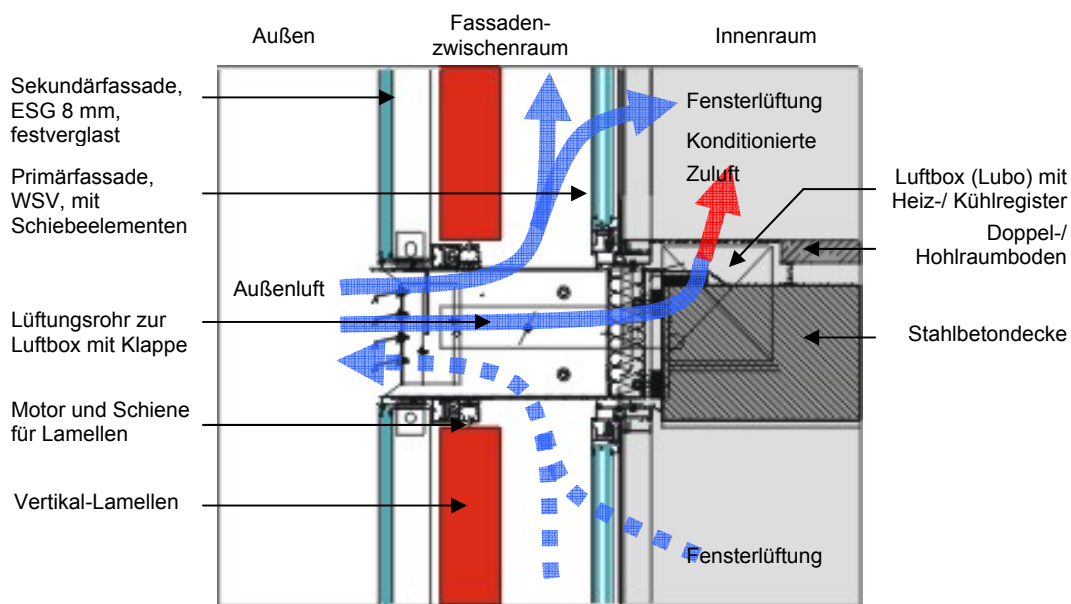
Detail: Deckenanschluss der Fassade mit den Lüftungsmöglichkeiten (Luftbox mit Heizfall)
